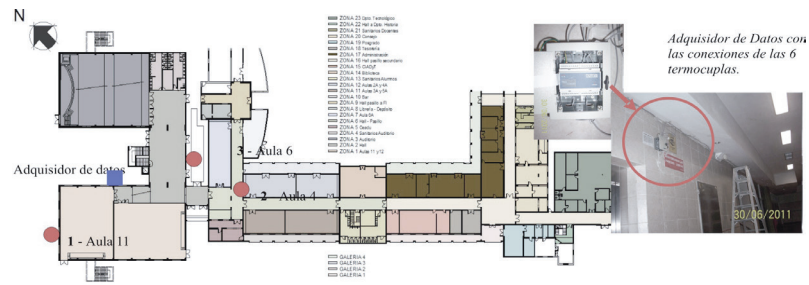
| Zonificación Planta Baja, FAU–UNNE y distribución de los sensores térmicos y módulo registrador.
